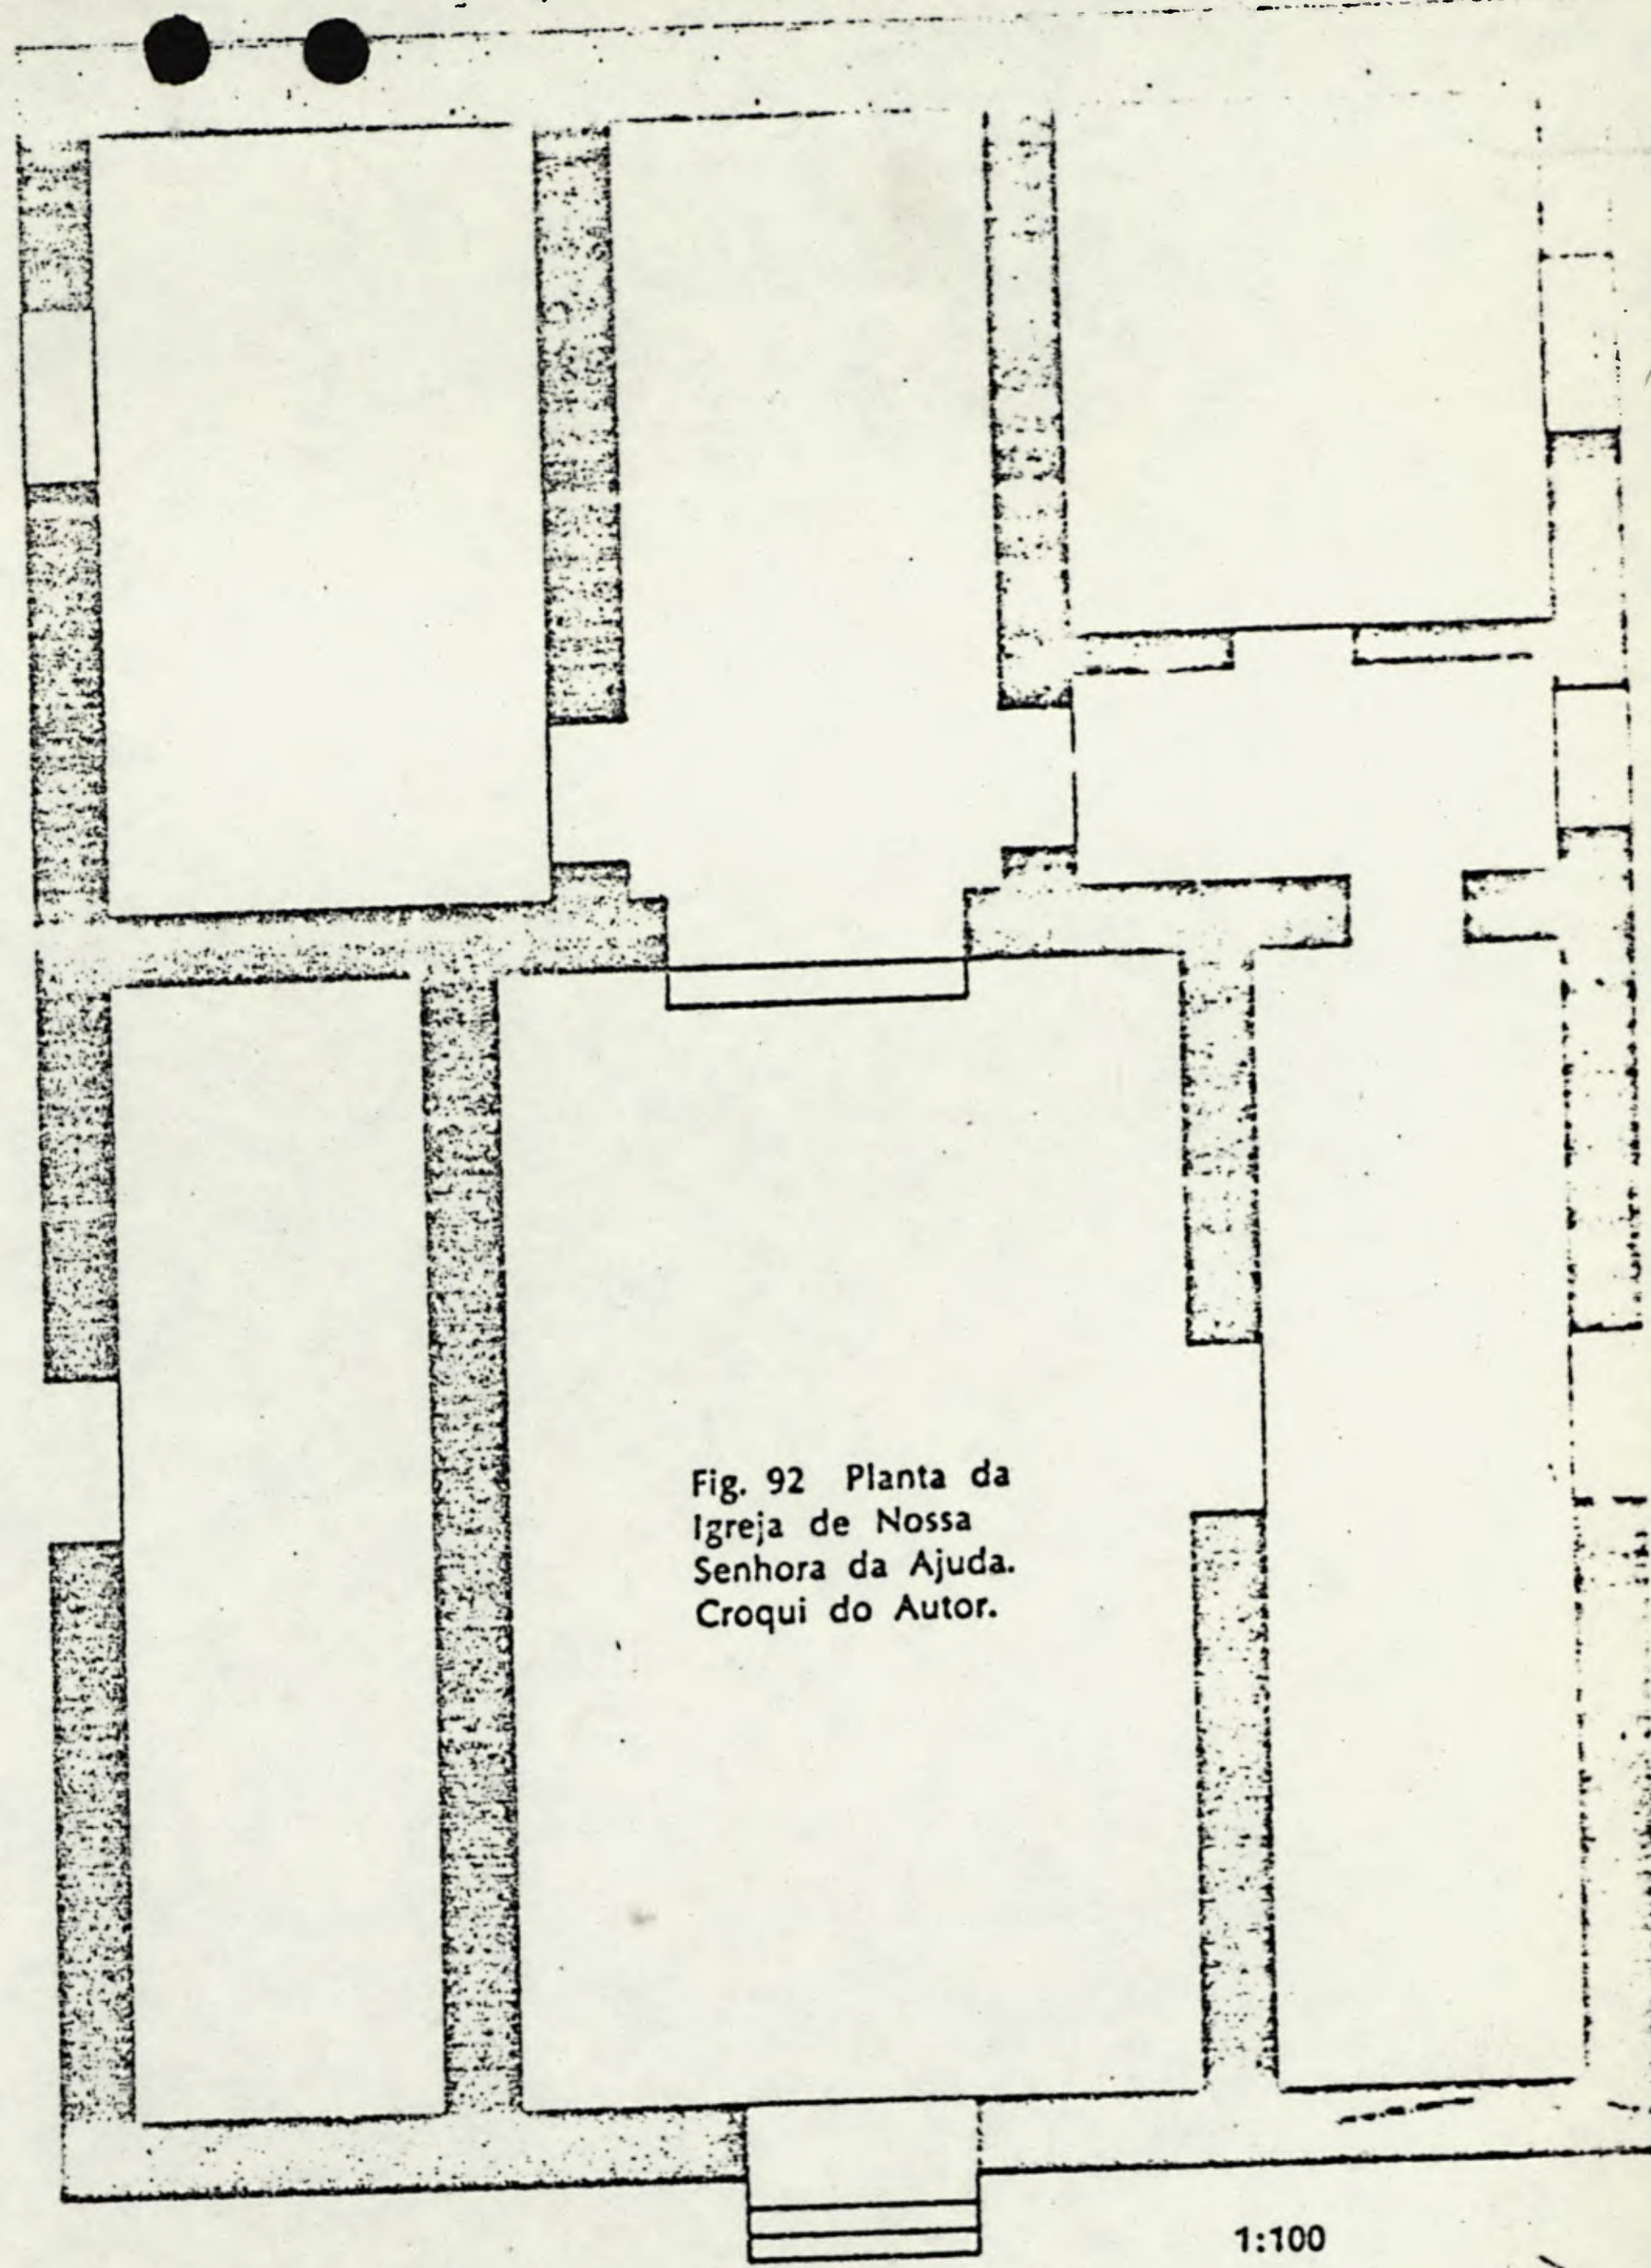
Planta da Igreja de Nossa Senhora da Ajuda. Croqui do Autor.
